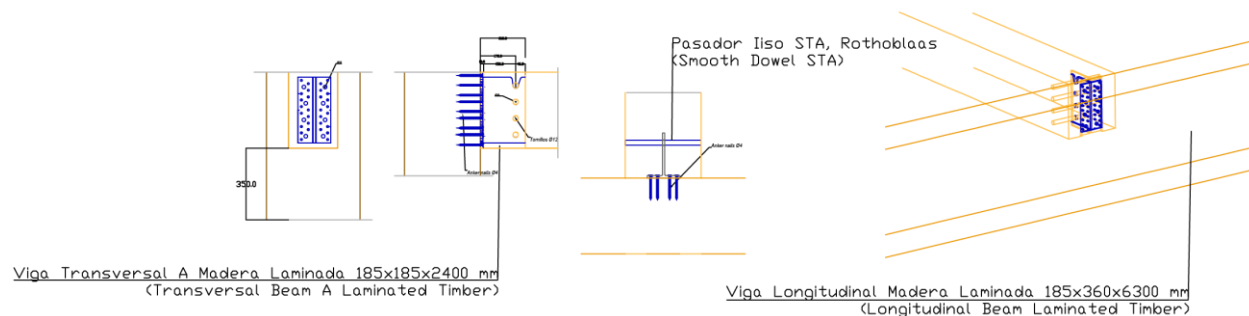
Detalles Técnicos inferiores prototipo Chile. Elaboración propia.
